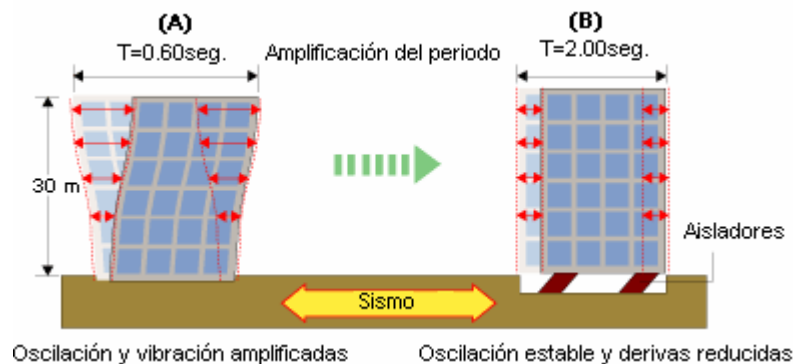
Respuesta sísmica de estructuras: (A) Estructura convencional, (B) Estructura con aislamiento sísmico en la base (www.oiles.co.jp/en/menshin/).
